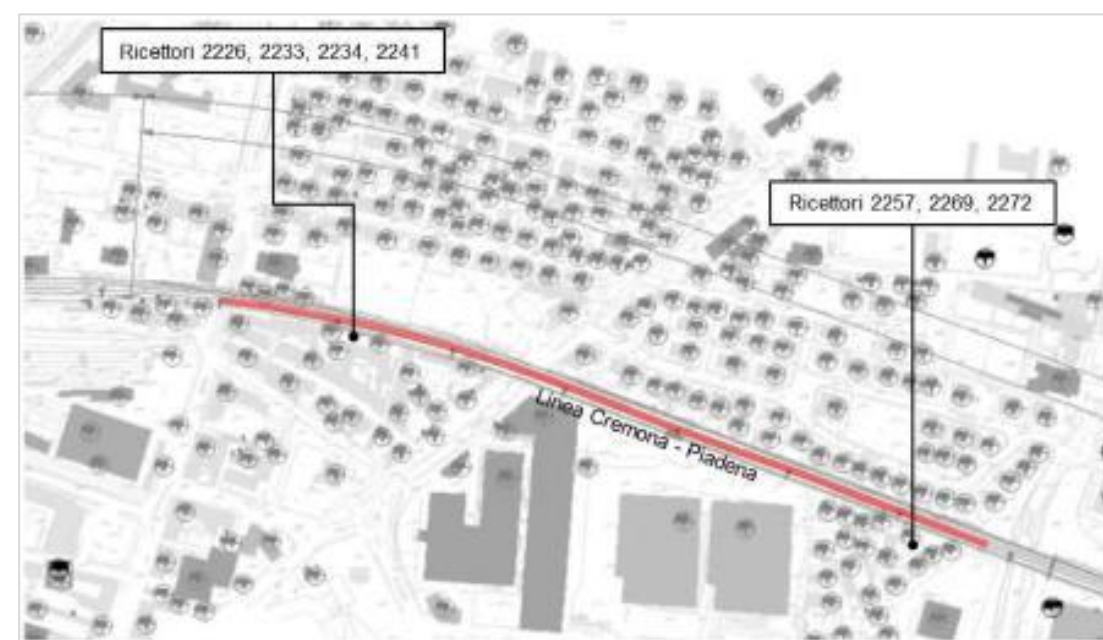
Planimetria ubicazione ricettori e posizionamento soluzione di mitigazione adottata
